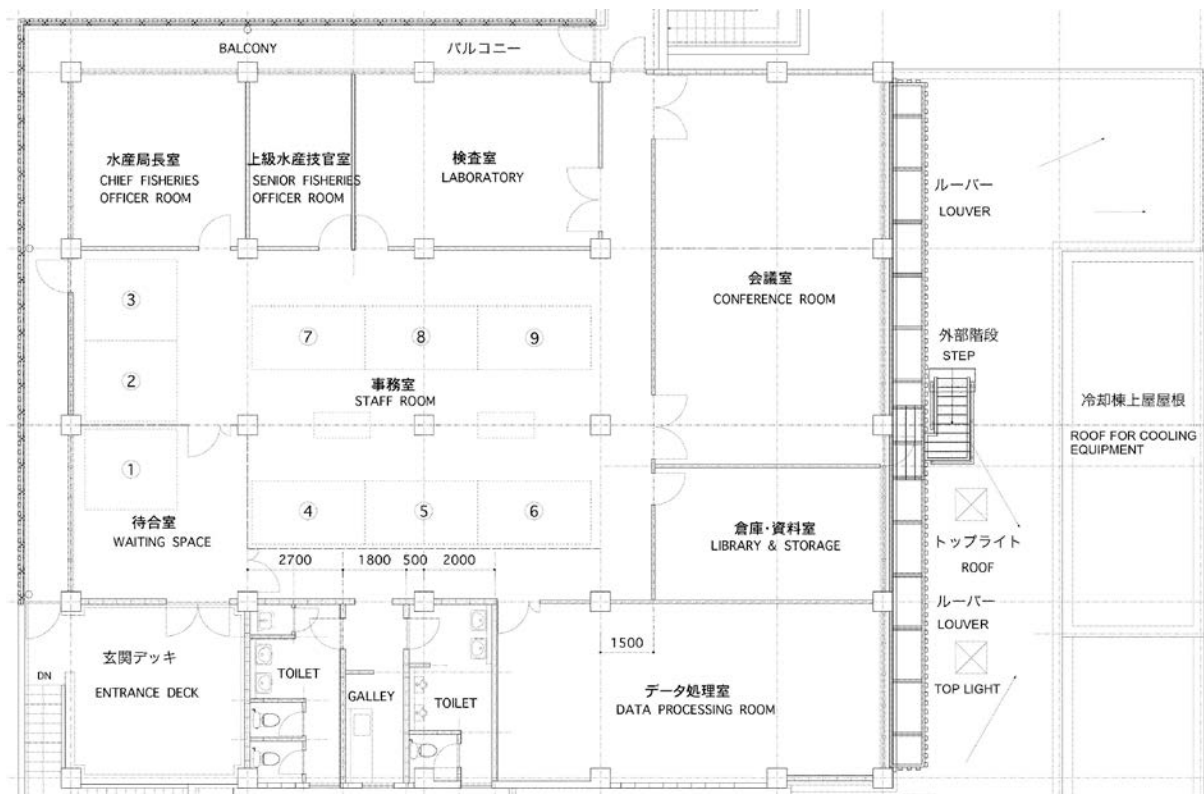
ロゾー水産コンプレックス 水産センター棟2階平面図
